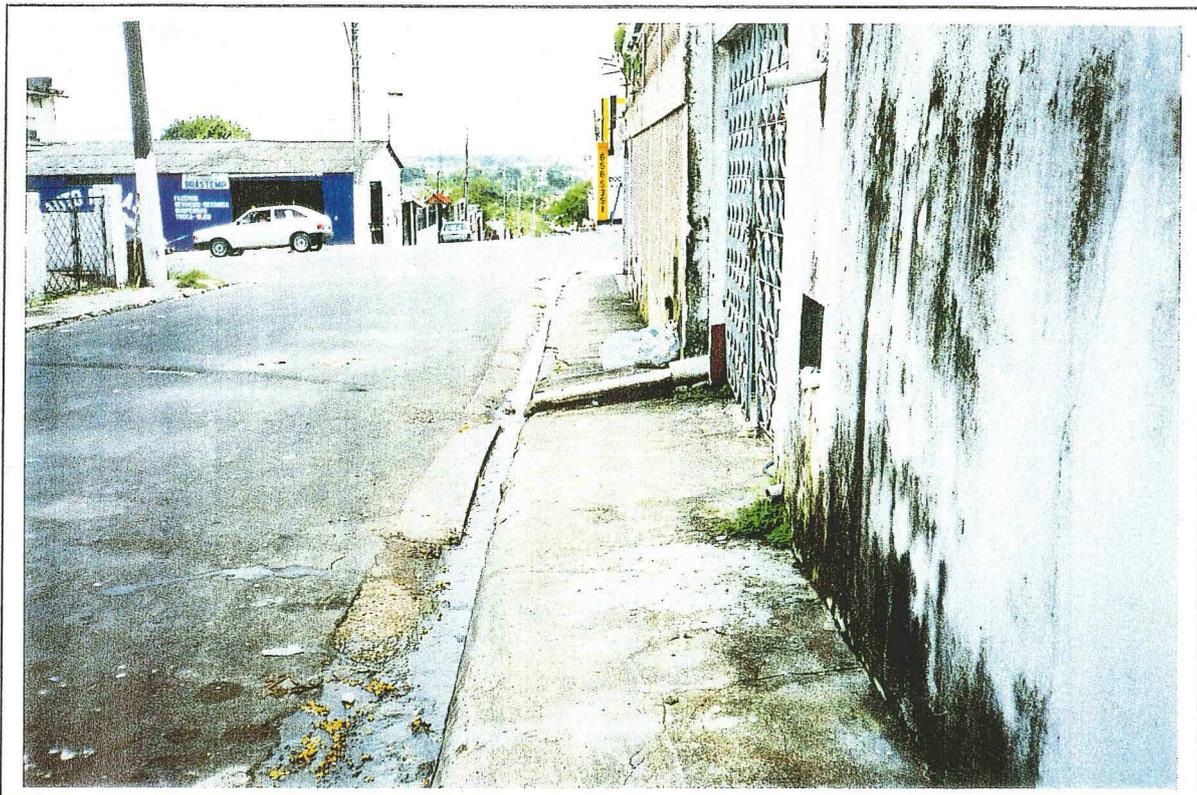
Conjunto D. Pedro - esgoto doméstico correndo na via ao lado da calçada, rua Mém de Sá - Foto do autor, fevereiro de 1996.
